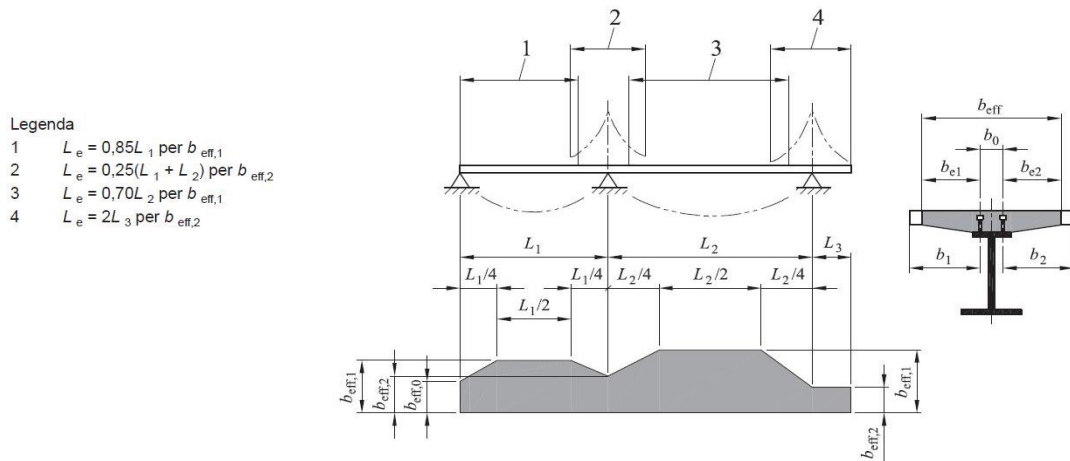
SCHEMA DI CALCOLO – PARTICOLARE SU PILA
